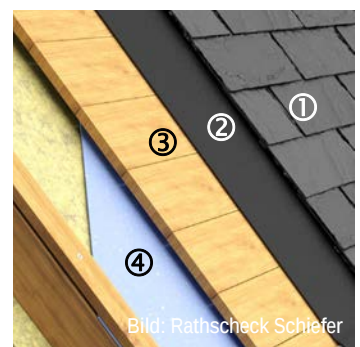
Schieferdach ① als belüftete Konstruktion mit Vordeckung ② auf Schalung ③ und Unterdeckung ④.
